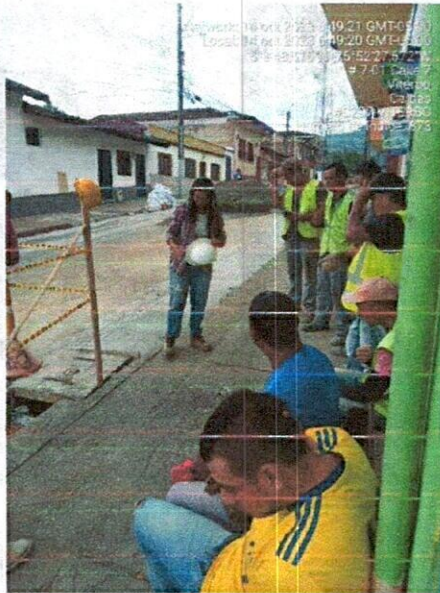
y 28: Vaciado de pavimento en calle 7 con carrera 7 y calle 7 entre carreras 6 y 7.
